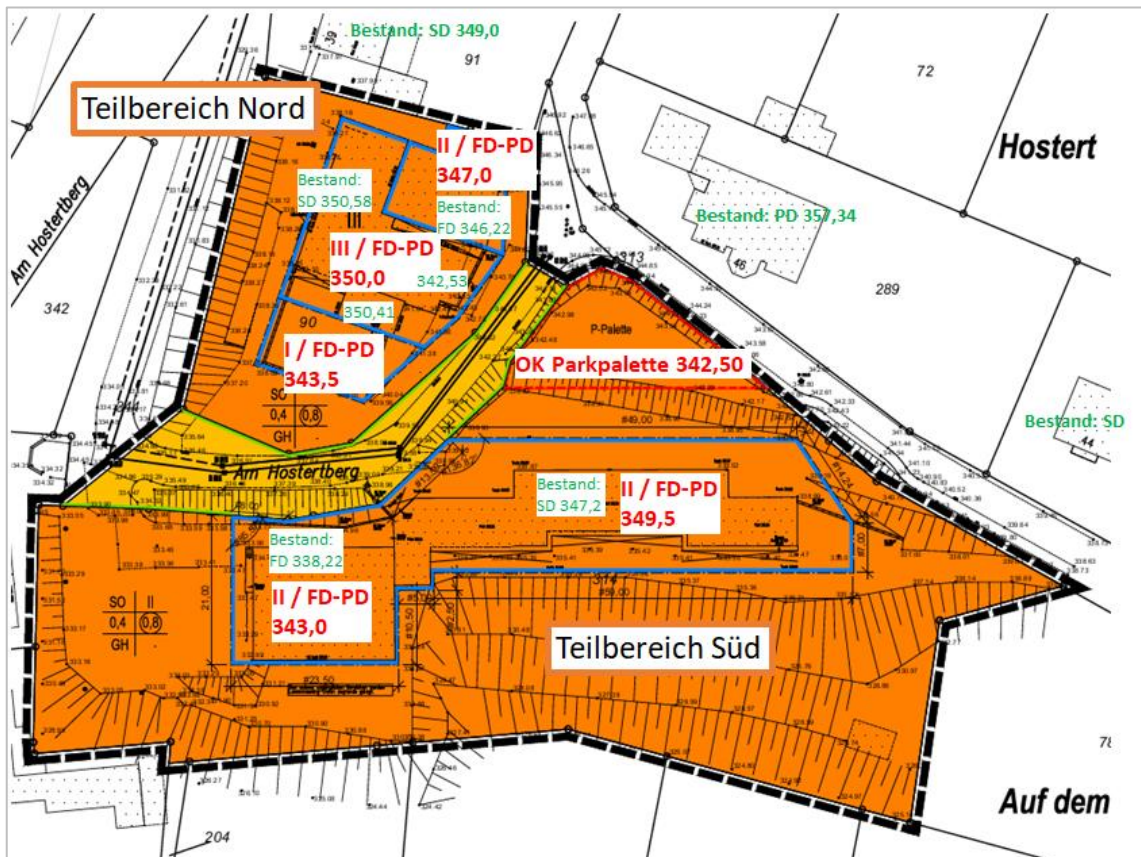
bestehende und geplante Dachformen und Gebäudehöhen im Plangebiet
